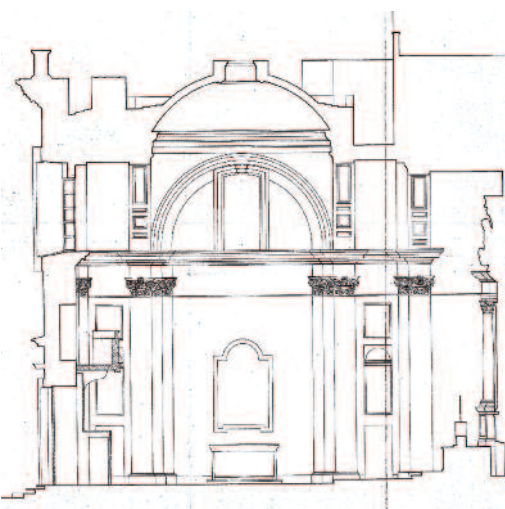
Sezione longitudinale della chiesa (rilievo dell'autore).
